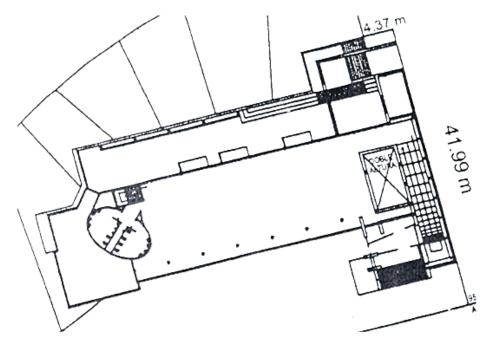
Planta arquitectónica baja, Mediateca municipal de Chihuahua.
